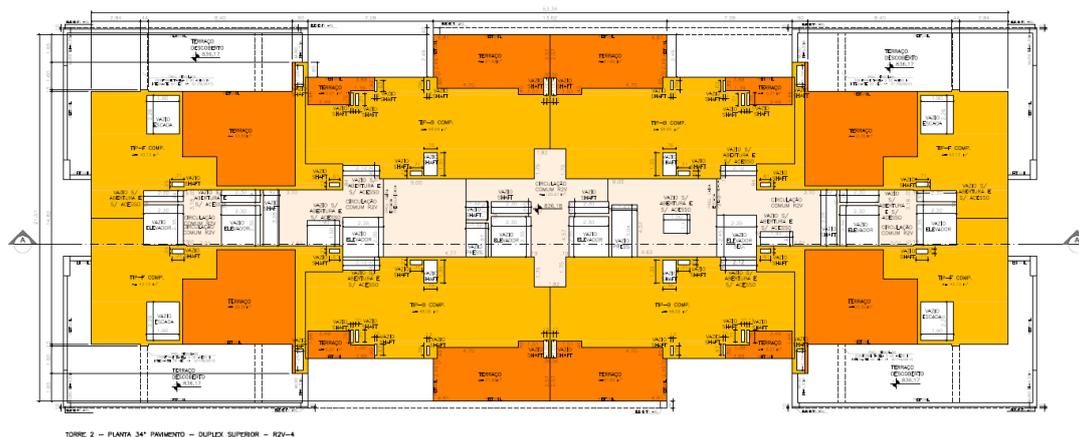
Planta do 34º pavimento da torre 2 do setor B1.
